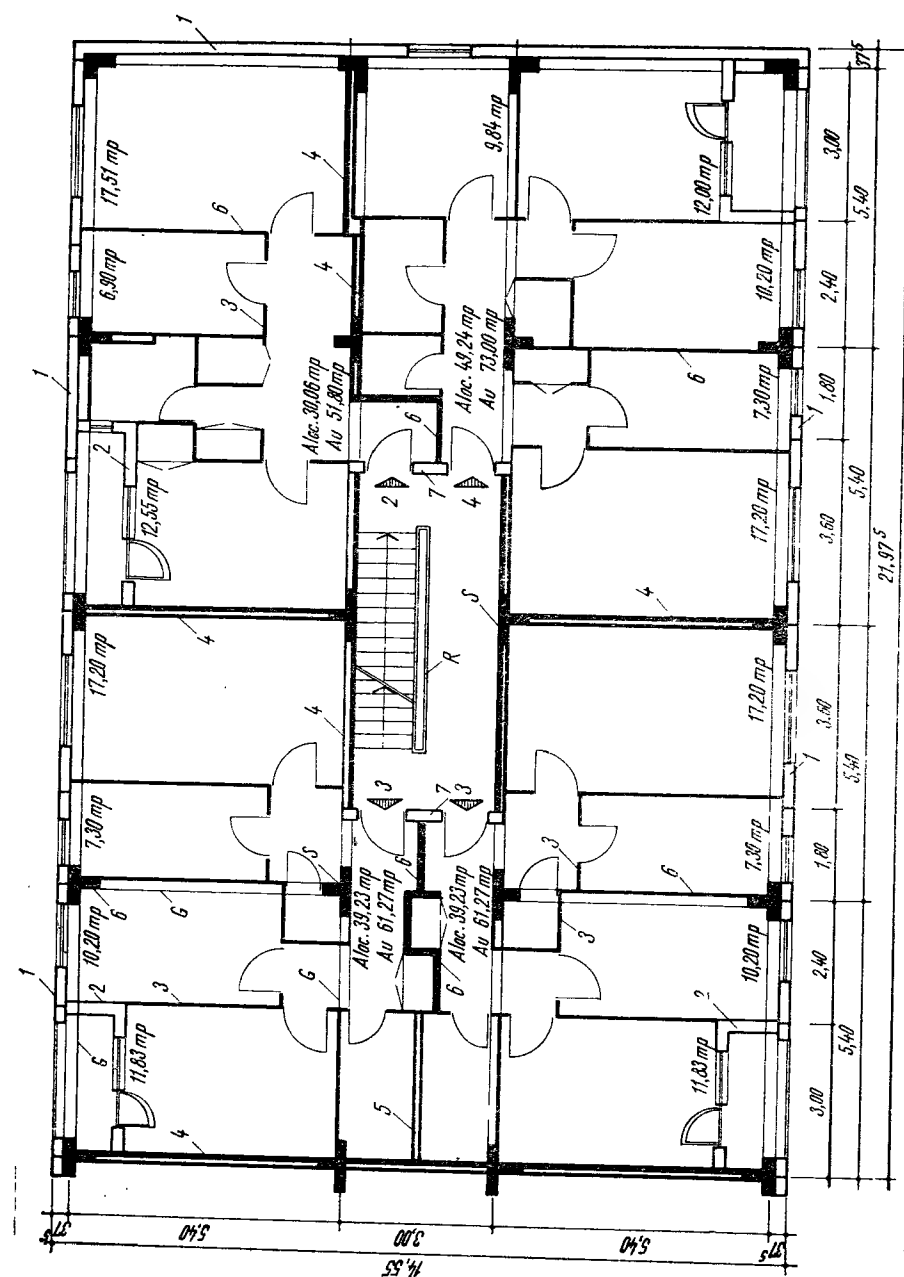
Plan etaj curent pentru o construcție de locuințe cu patru apartamente la scară și cu structura de rezistență din cadre lamelare de beton armat (proiect ICPROM - Iași):
